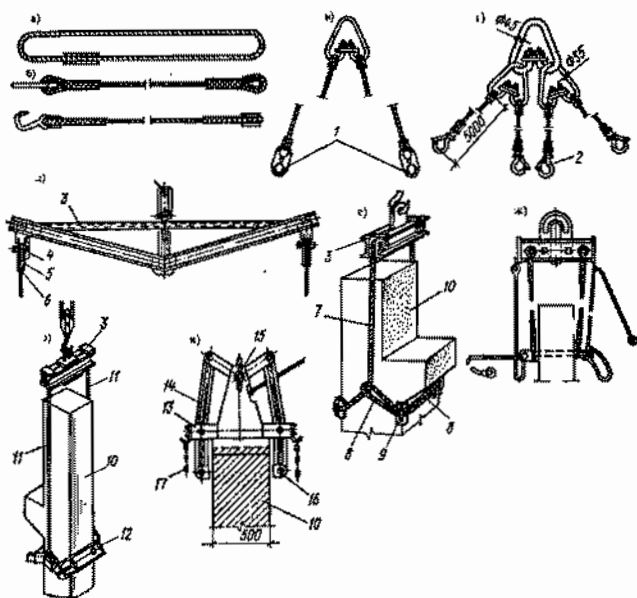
Грузозахватные монтажные приспособления: 1 - карабины; 2 - крюки; 3 - траверса; 4 - кабель; 5 - электрозахват; 6 - коуш; 7 - облегченный строп; 9 - подкладки; 10 - колонна; 11 - подвеска; 12 - щеки захвата; 13 - рама; 14 - рычаг; 15 - подвижный вал; 16 - прижимные башмаки; 17 - предохранительные цепи
